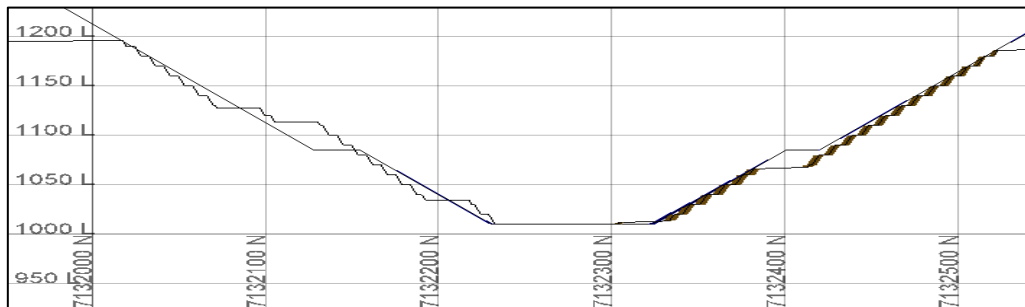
LG1Y Fase 3 - Vista en sección - Corte secundario N-S E394150
